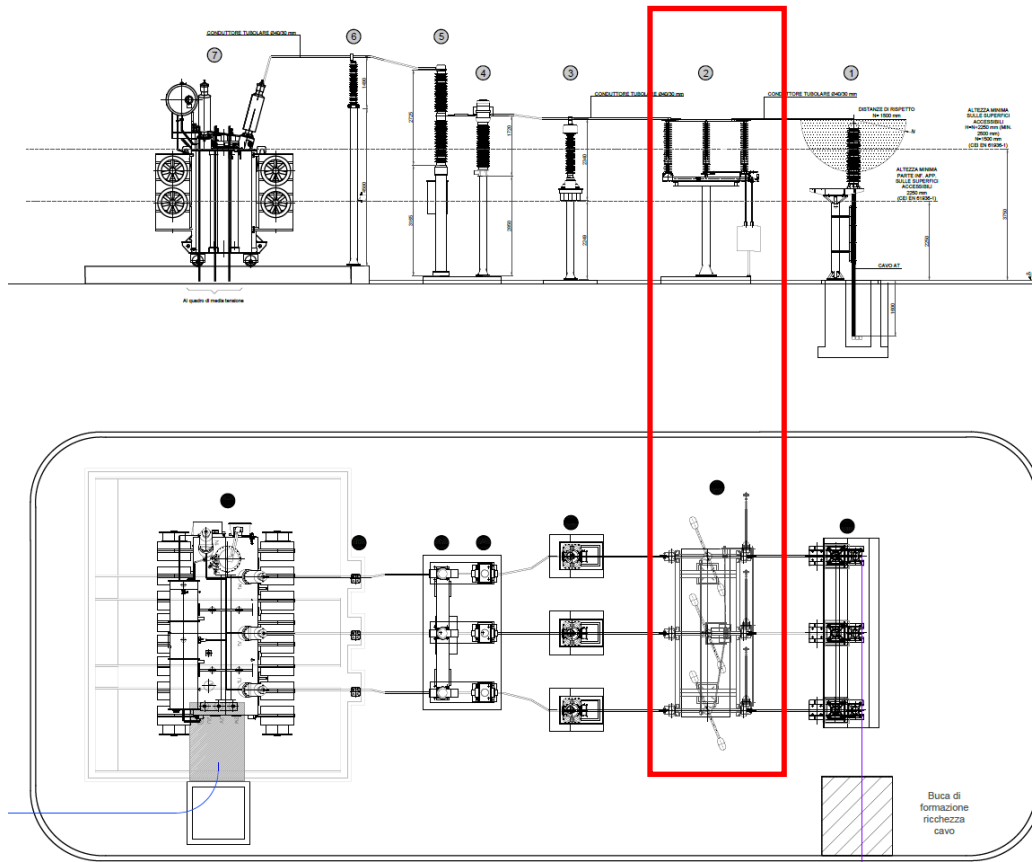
Prospetto e planimetria degli elementi della sottostazione utente.
